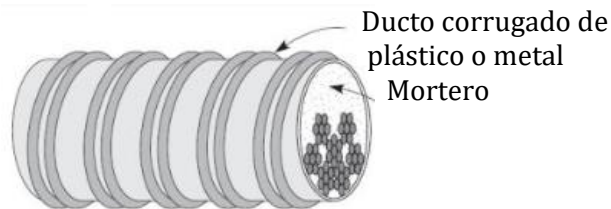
Sistema adherido (Adaptado de Marshall y Robberts, 2000).
